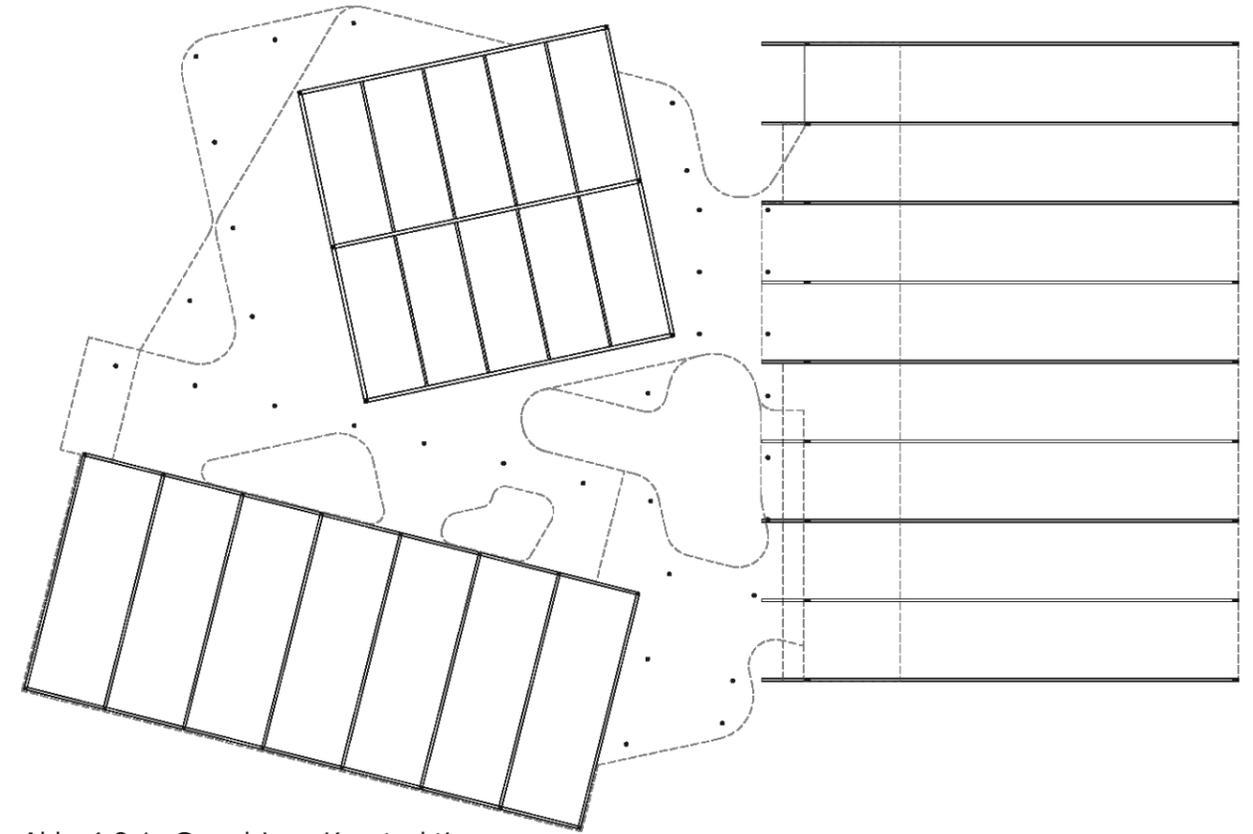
Grundriss - Konstruktion
